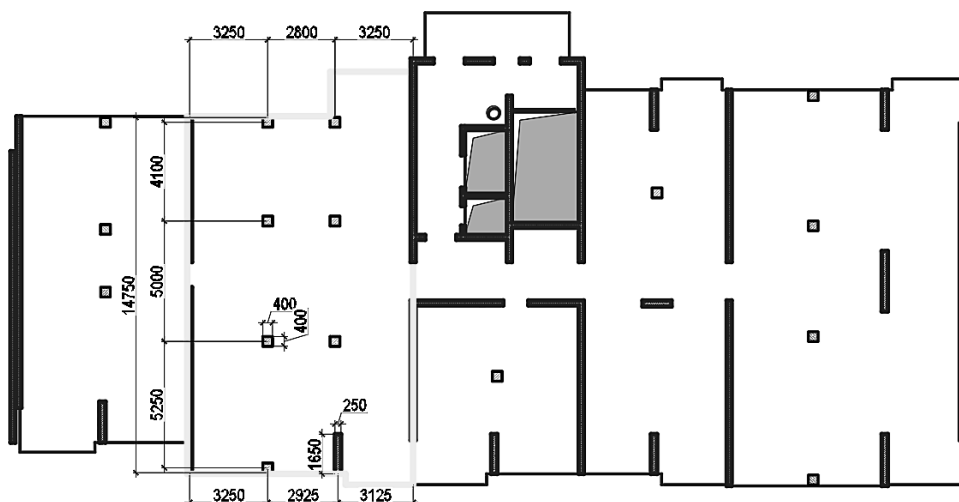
Залізобетонна монолітна плита перекриття
